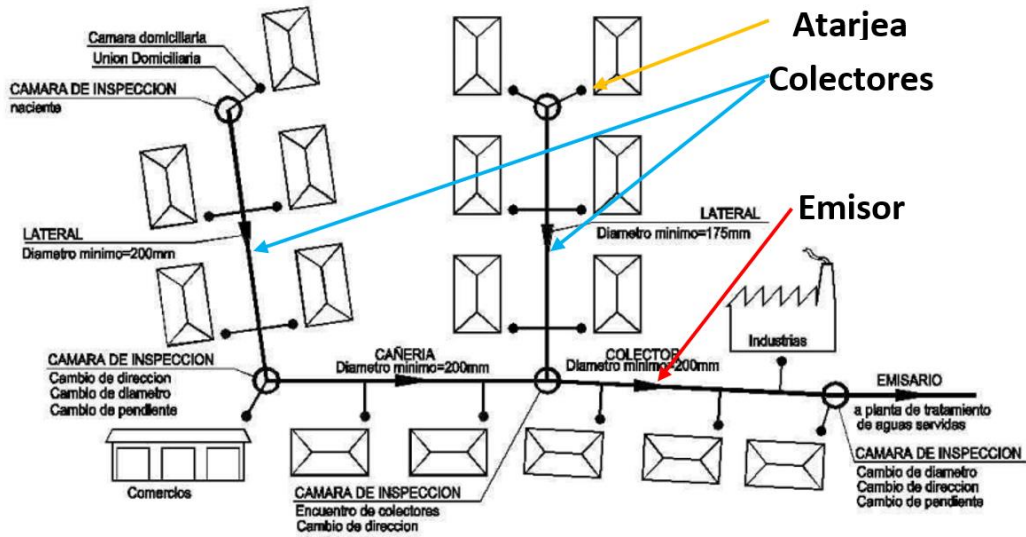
Distribución de las tuberías de una red de alcantarillado. Fuente: Brüning, 2018.
